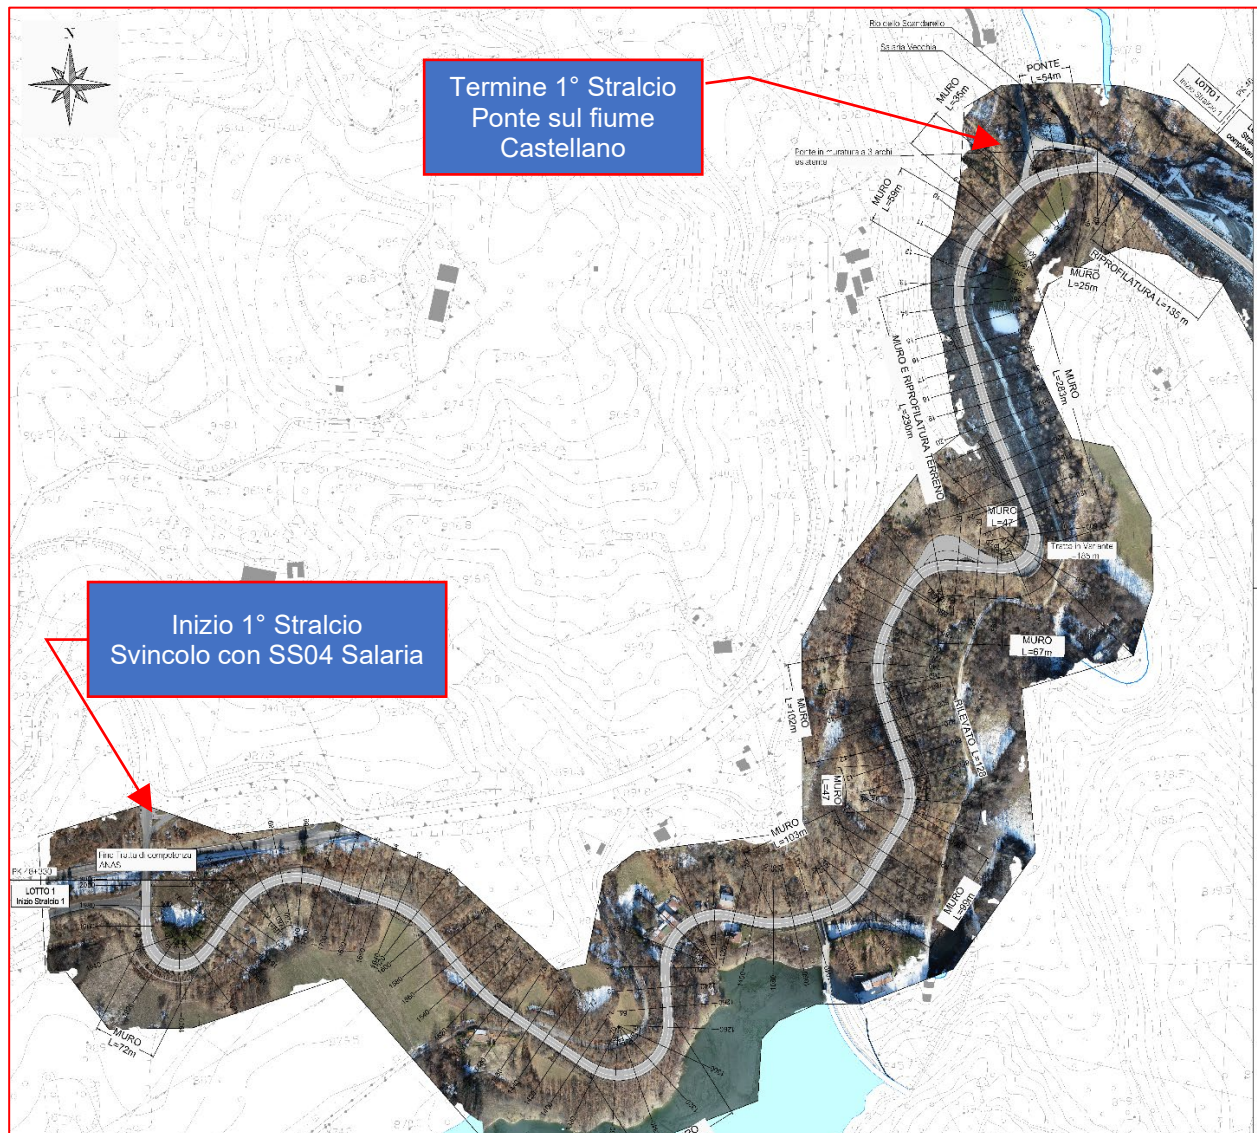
Tracciato della S.S. 260 Picente oggetto dell'intervento
